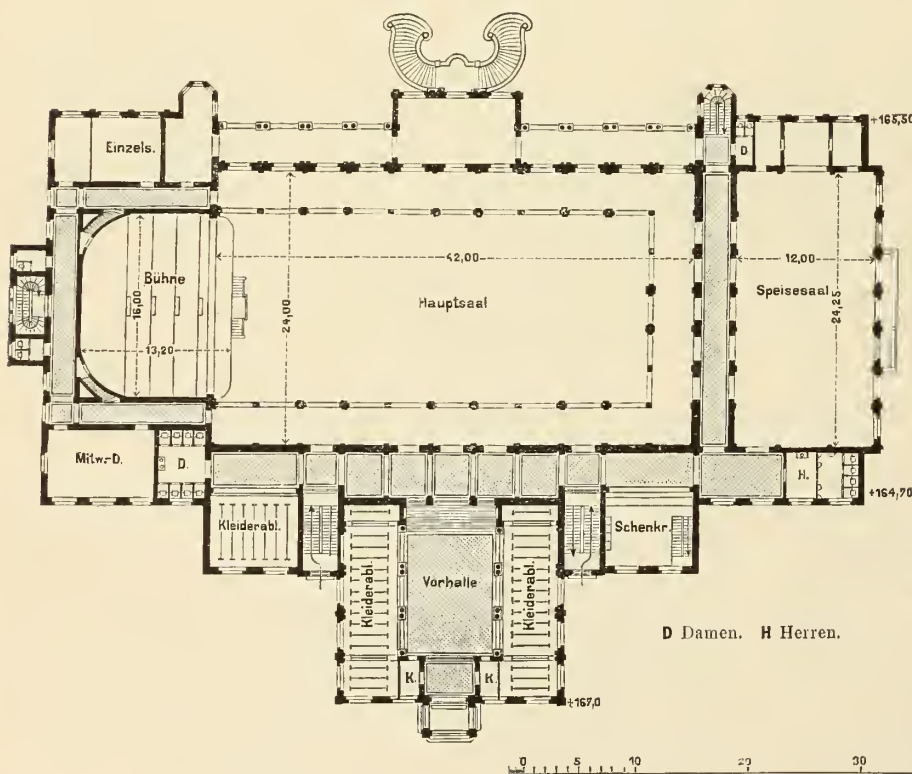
Grundriss vom Erdgeschoss.
